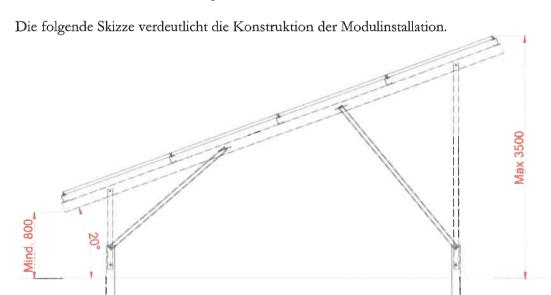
Skizze der Modulkonstruktion (Quelle: Planungsunterlagen, Bsp.)
